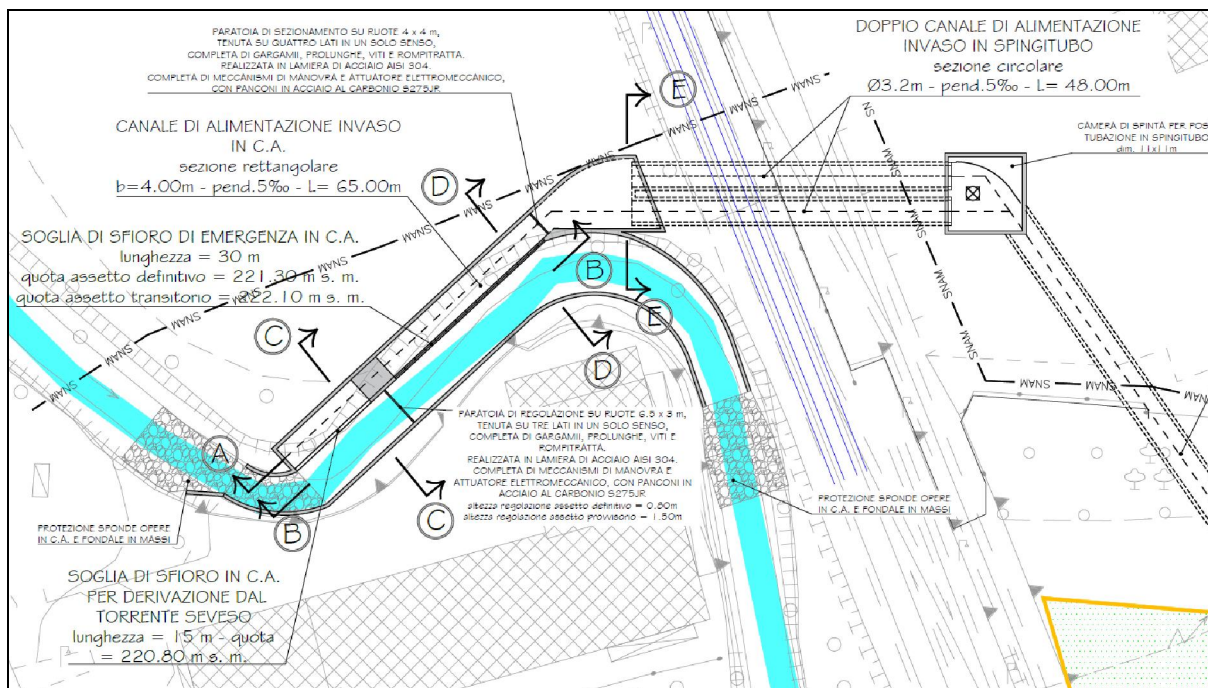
Planimetria di progetto dell'opera di presa dal T. Seveso
